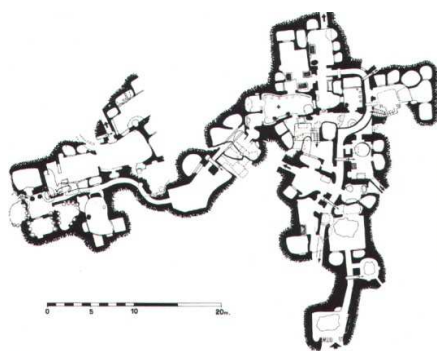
Planta y secciones viviendas en Matmata, Túnez.
